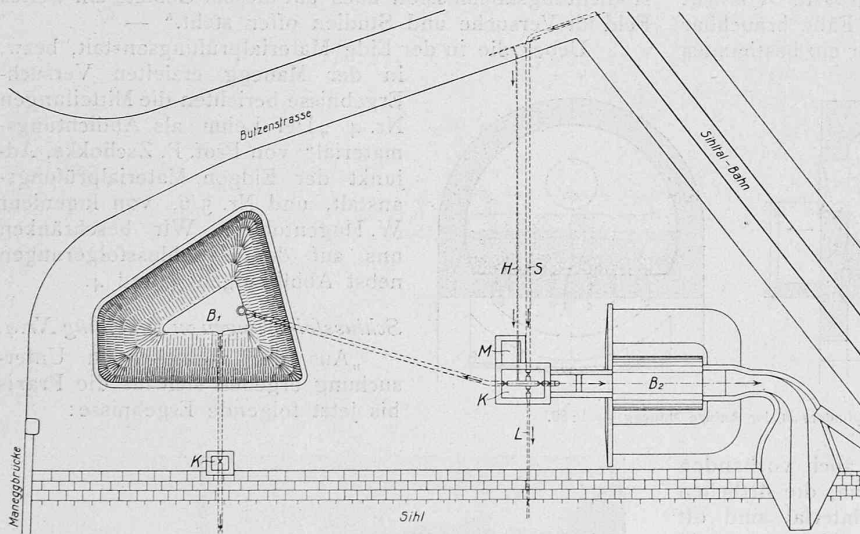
Lageplan der Versuchsanlage Manegg, 1:400. — LEGENDE: B₁ Offenes Bassin, B₂ Druckzylinder, H Hydrantenleitung, S Sihlwasserzuleitung, M Wassermesser, K Schieber- u. Mess-Schächte, L Leerlauf.
